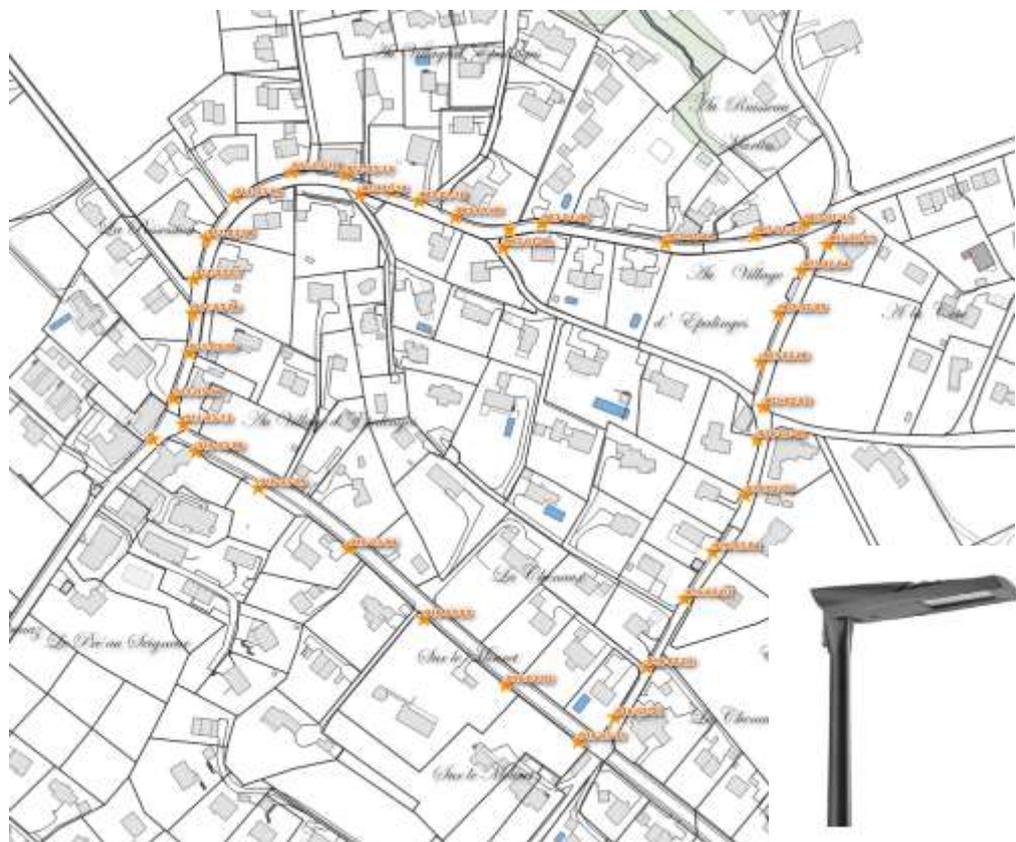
Plan de situation des luminaires existants sur le secteur concerné par les travaux et photographie d'un point lumineux
